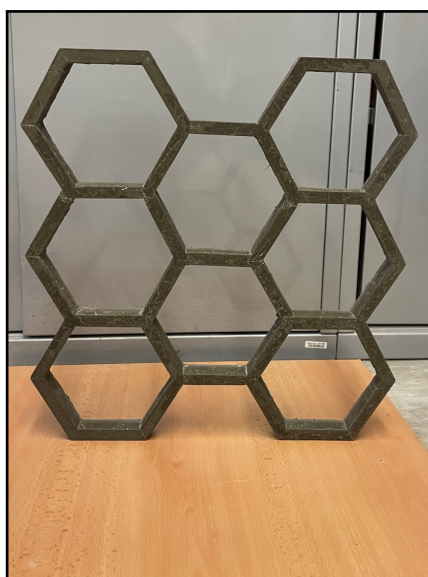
Vybetonovaný prvek PRK č. 2.1
